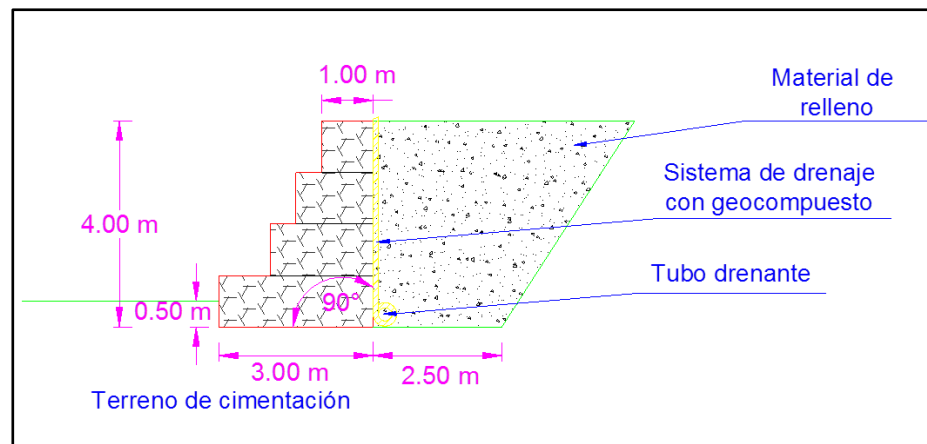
Detalle del muro colocado al centro del talud 5.
